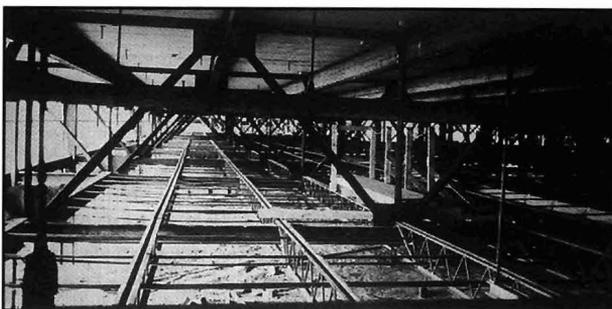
Woodhull Medical Center de Brooklin, Nueva York. Vista de la planta intersticial en construcción.
